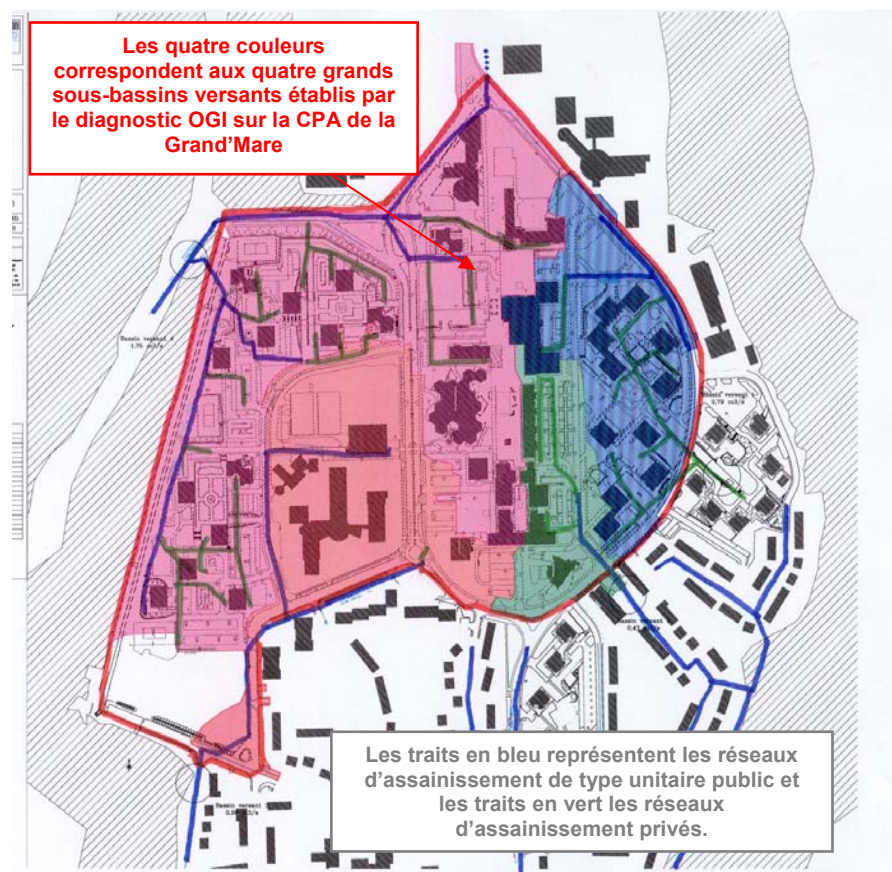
plan des réseaux unitaires au droit du site (source : OGI)
